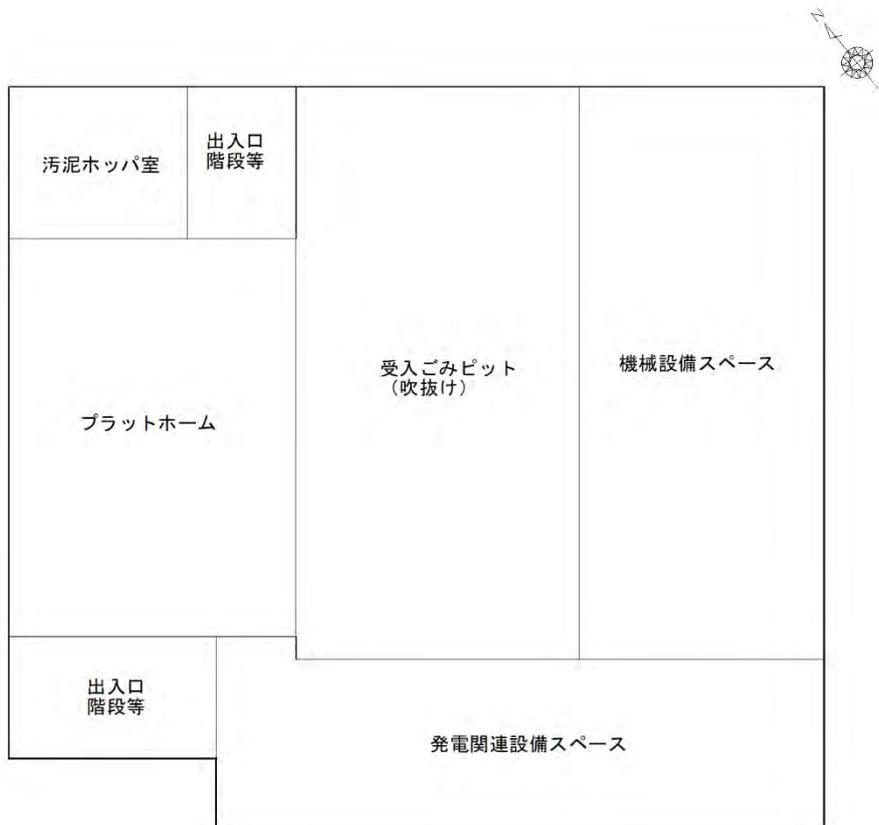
(2) 廃棄物受入棟平面図 (1階)
